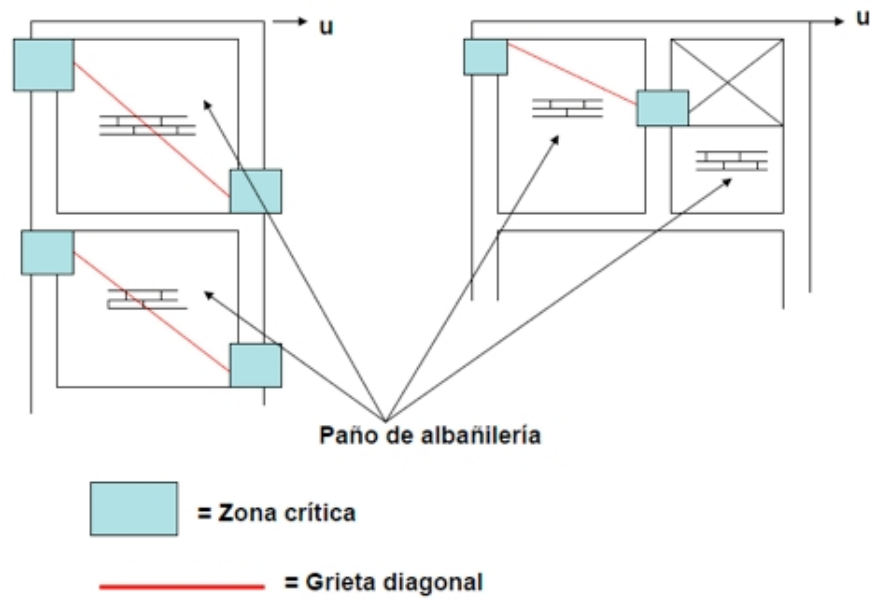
Zonas críticas en los pilares de confinamiento cuando el desplazamiento del muro es hacia la derecha (Astroza, 2008)
